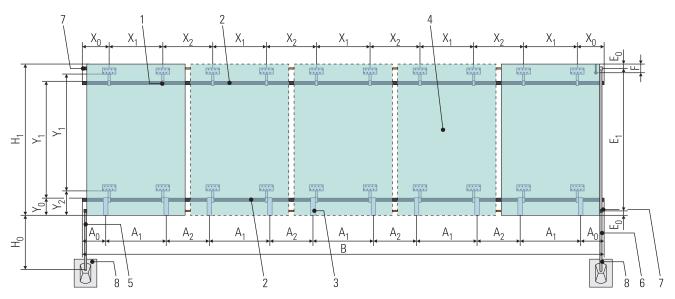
Dimensione principale di un campo di collettori Solaris per il montaggio su tetto (nel disegno, collettore V26A)
